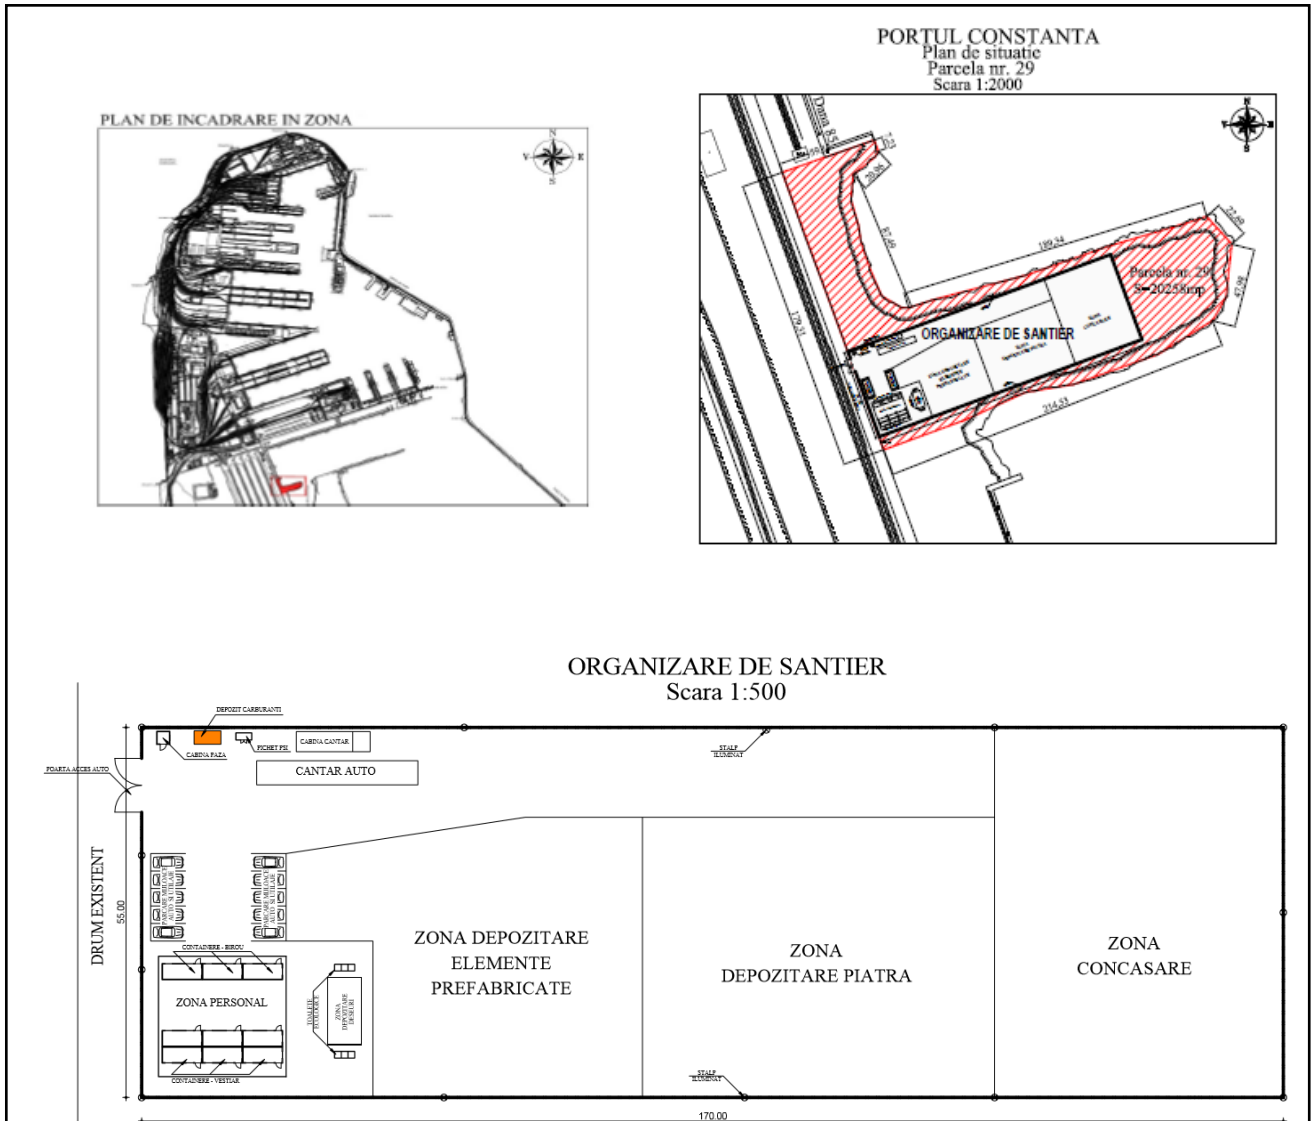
Amplasarea organizarii de santier ( sursa : Plansa 01 – AllPlan Proiect)
